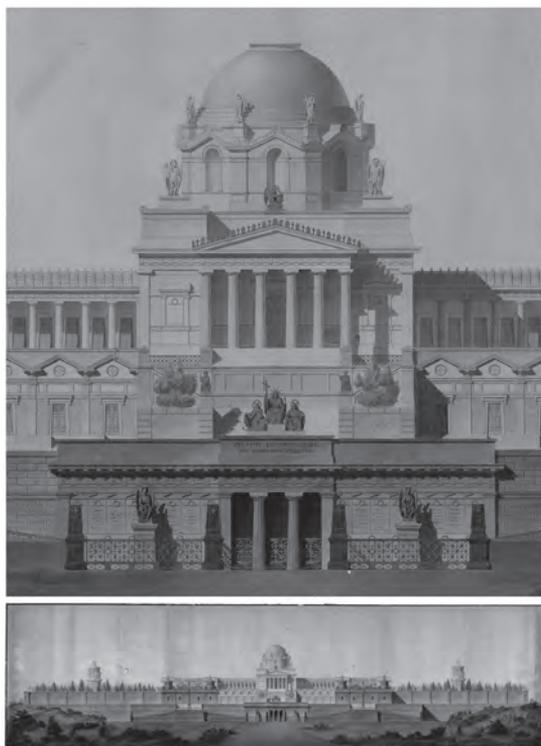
Prospetto principale (Archivio Giuseppe Damiani Almeysa di Palermo).
